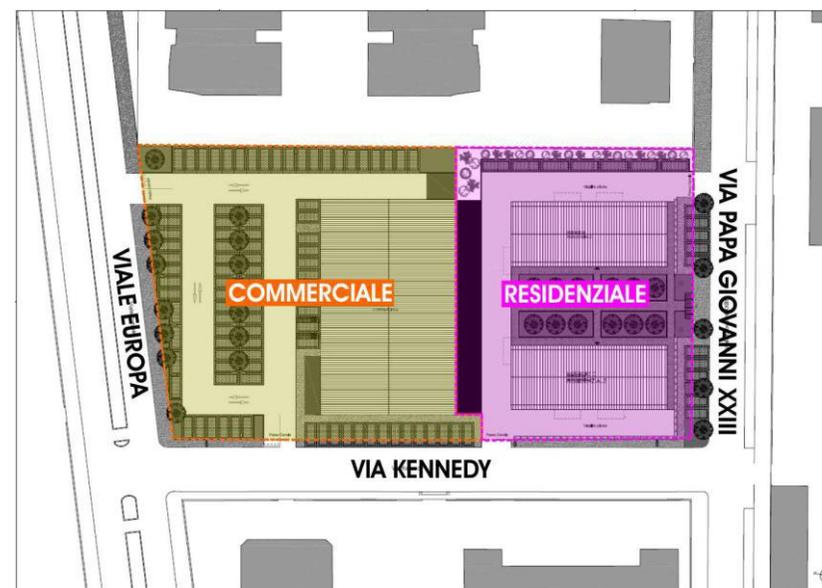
Progetto planivolumetrico dell'intervento – Mix funzionale
